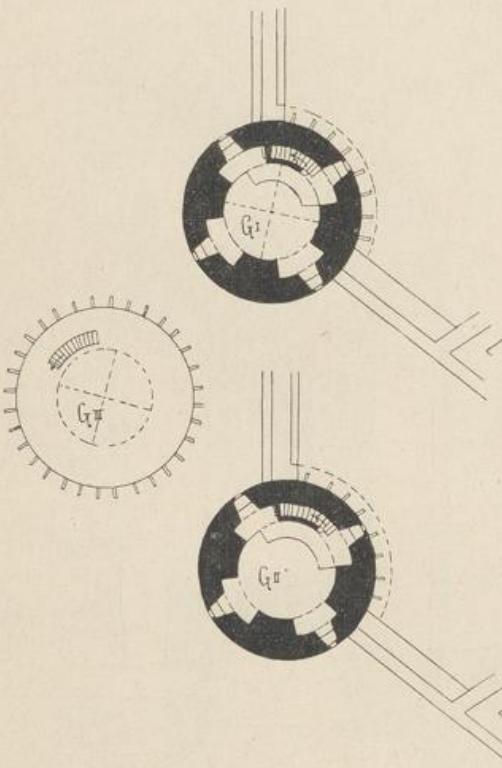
Schloss Linn. Grundrisse des Hauptturmes.
